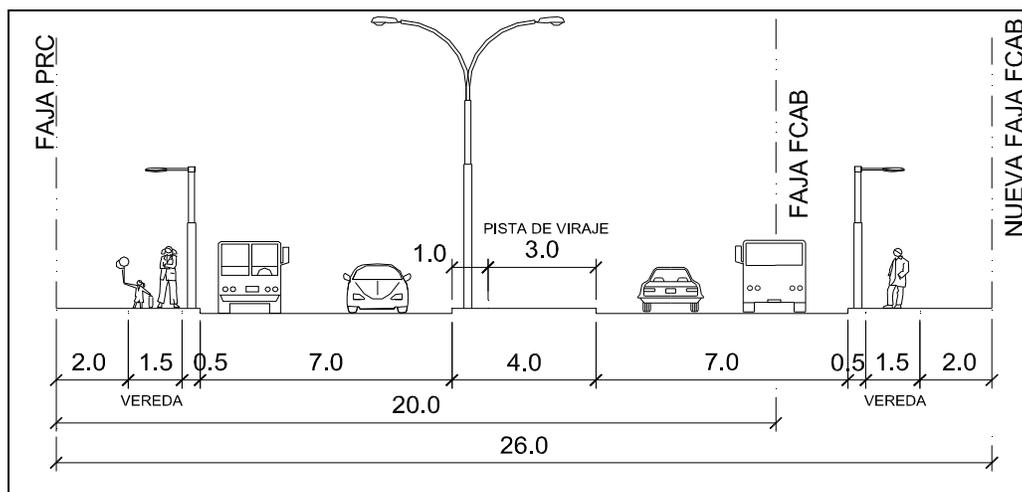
Perfil de 26 m, en primer sector de proyecto, Inicio – Puente Loa.
